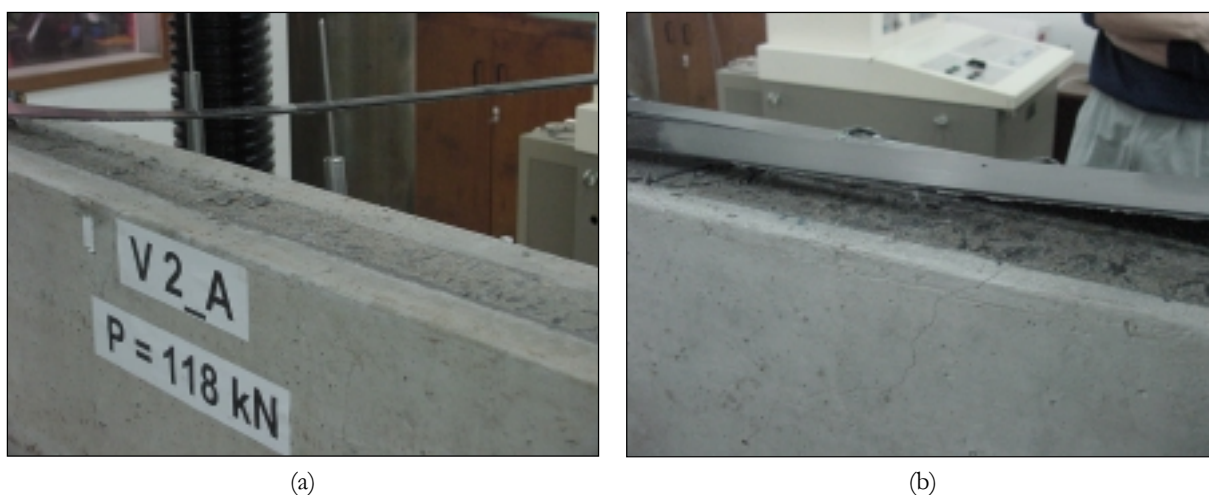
Aspecto geral do descolamento nas vigas reforçadas com laminado pré-fabricado
